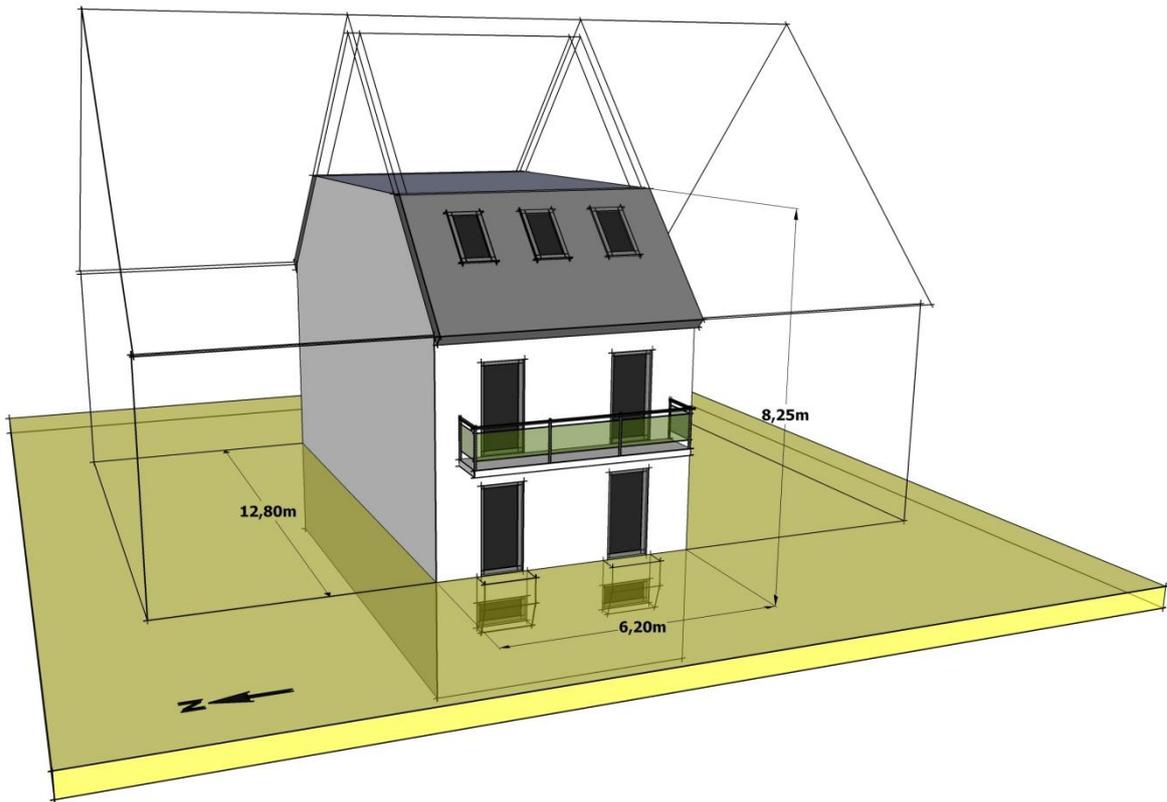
Reihenmittelhaus mit Keller- Ansicht Nord-West
